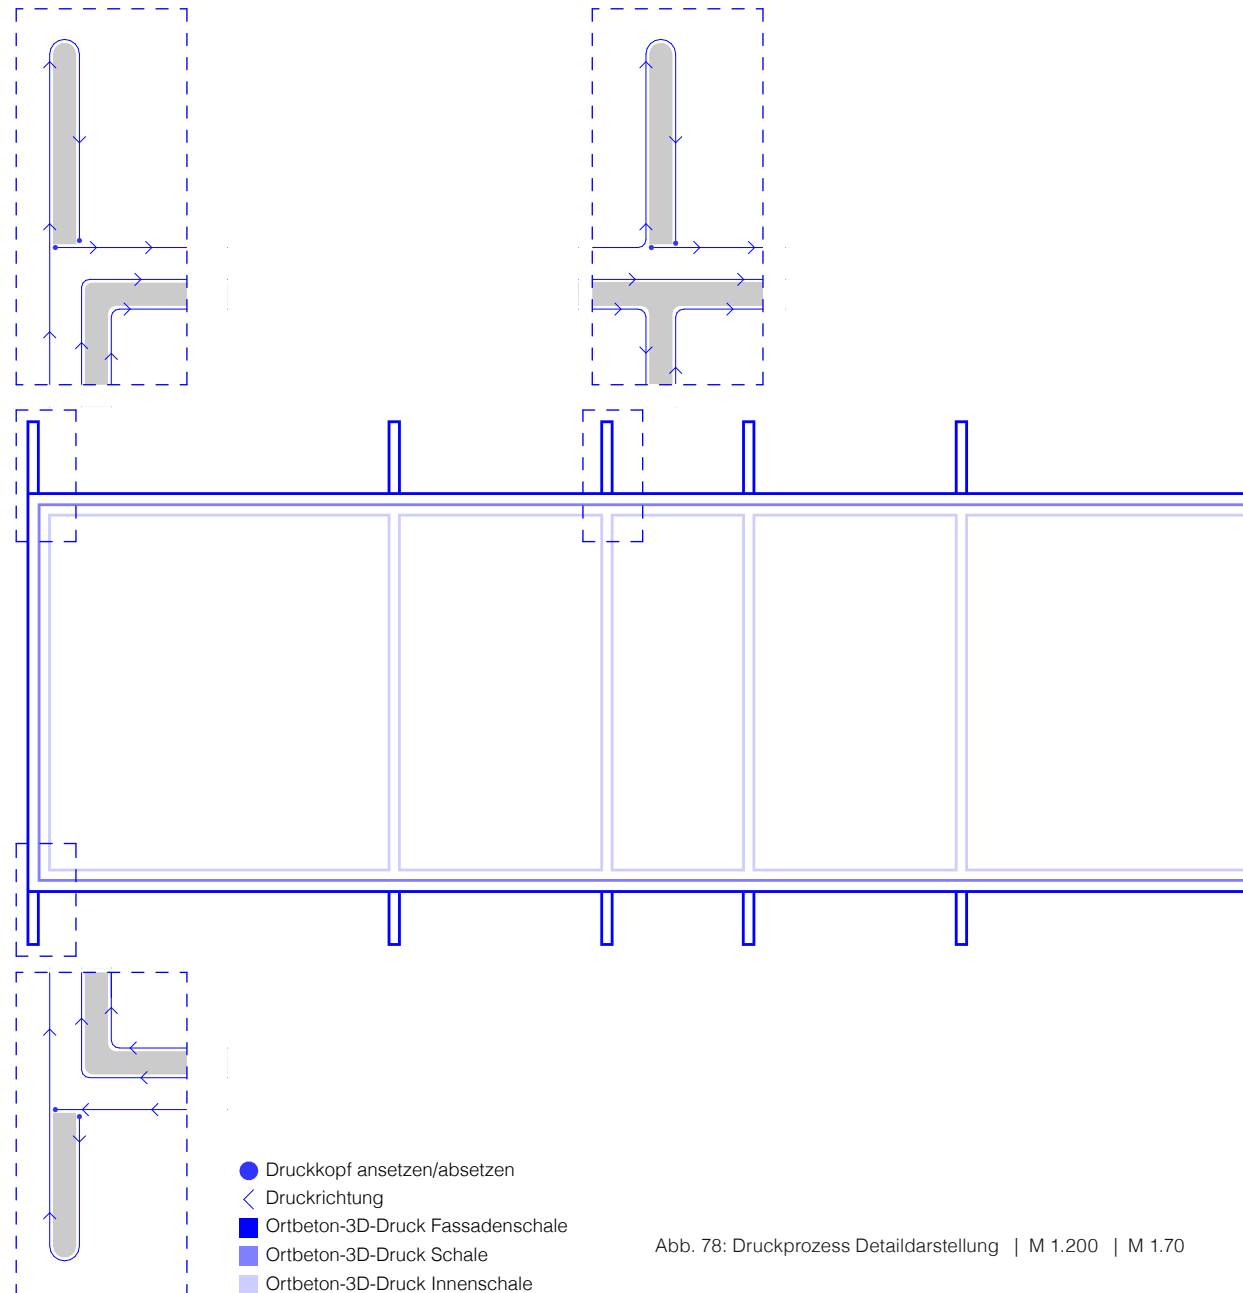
Druckprozess Detaildarstellung | M 1.200 | M 1.70
